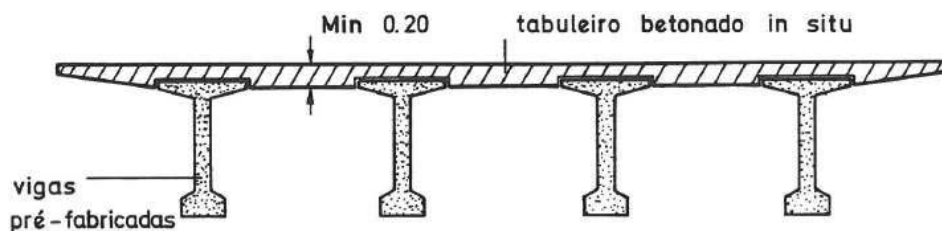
Ponte em laje vigada com vigas pré-fabricadas (Reis, 1999).
